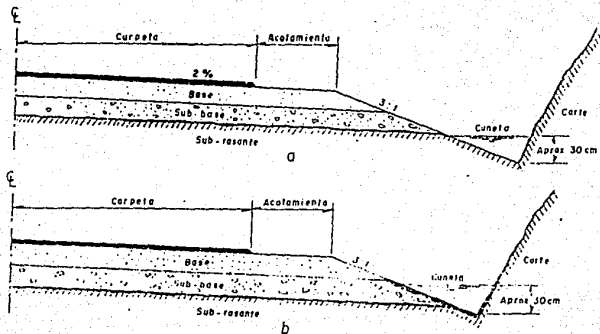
Disposición más conveniente de la cuneta, respecto al pavimento. Sección en corte, sin solapaje.
